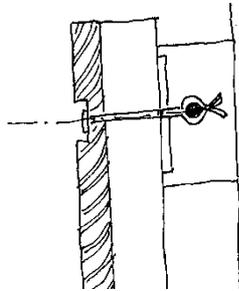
Pormenor – ligação do painel à estrutura da cobertura.
